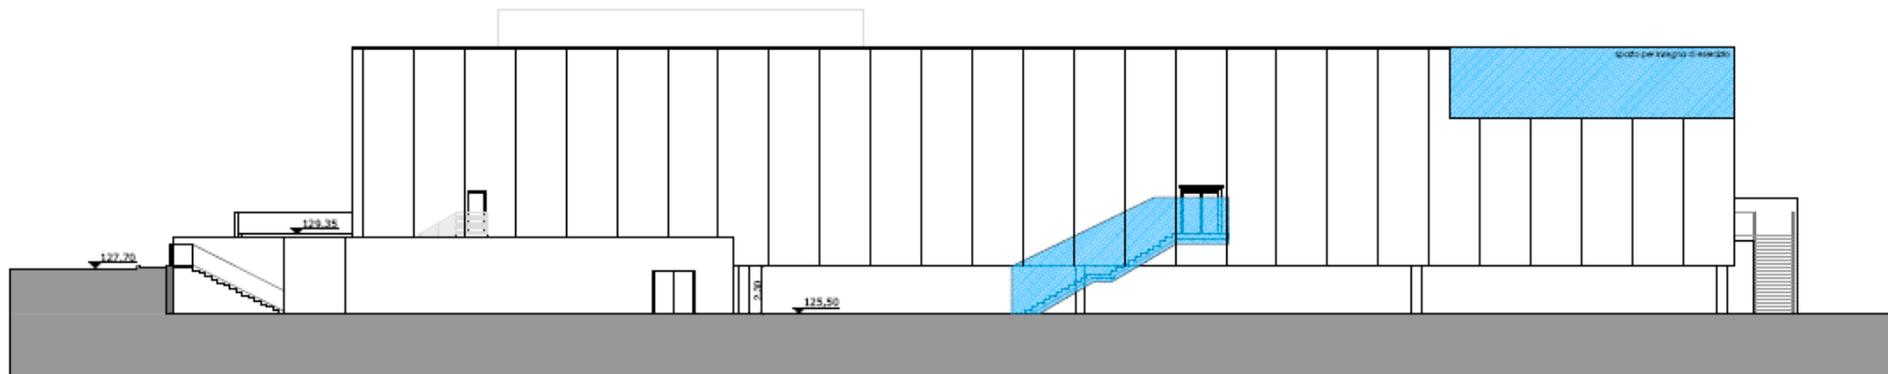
Prospetto Nord (Variante approvata - Tavola 3b)
